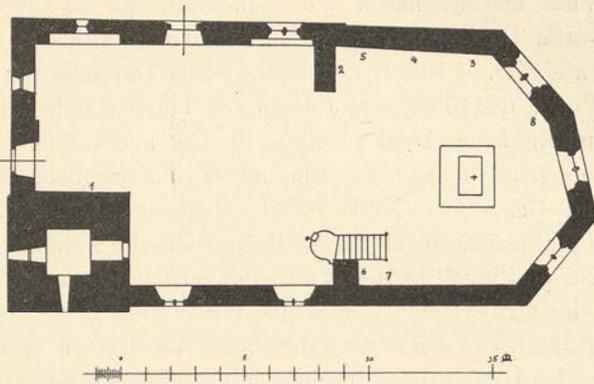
St. Johannisberg. Evangelische Pfarrkirche Grundriss.
